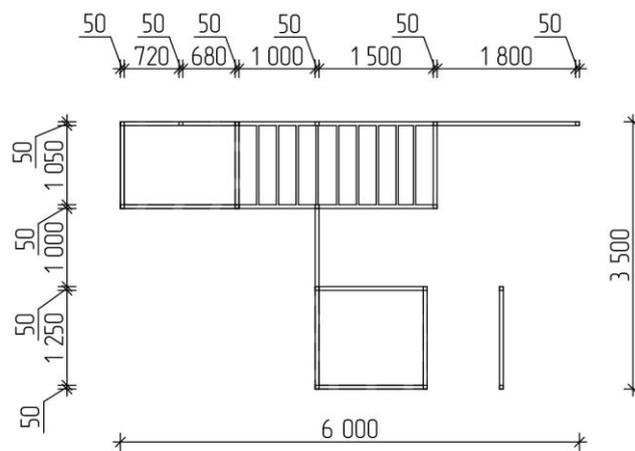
Чертеж разминочного лаза. Вид сверху
